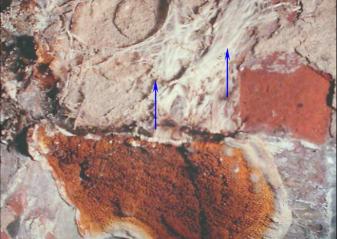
Stränge versorgen einen faltig gewundenen Fruchtkörper des Echten Hausschwammes und durchziehen das Mauerwerk (†); das Mauerwerk wurde aufgeschlagen.
